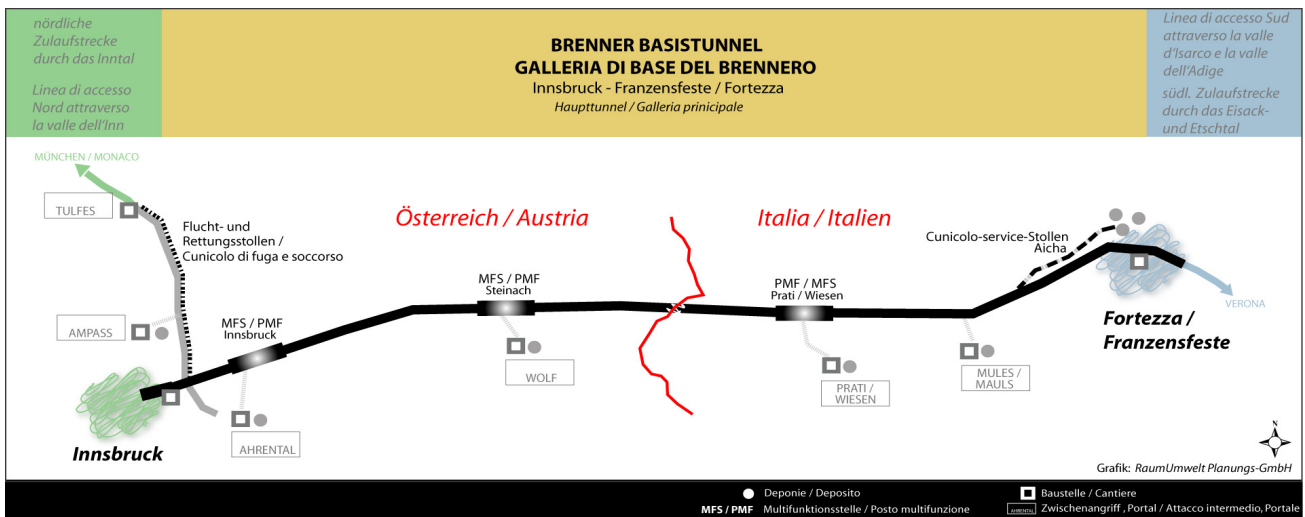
Übersichtslageplan des Brenner Basistunnels (Schema)
